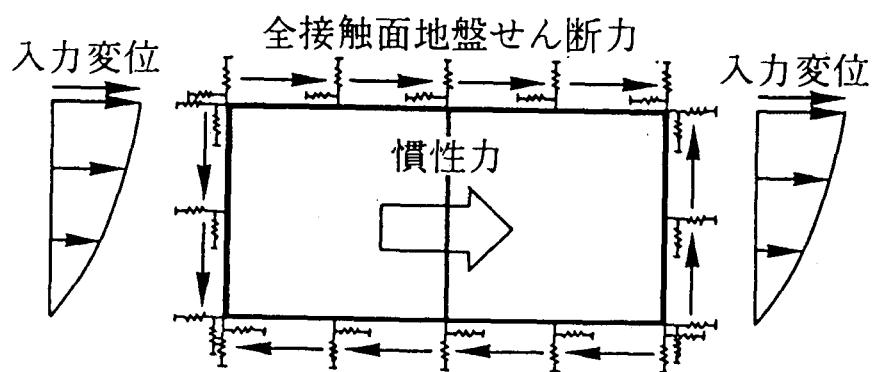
応答変位法による線状地下構造物の横断面方向の耐震解析²⁷⁾
